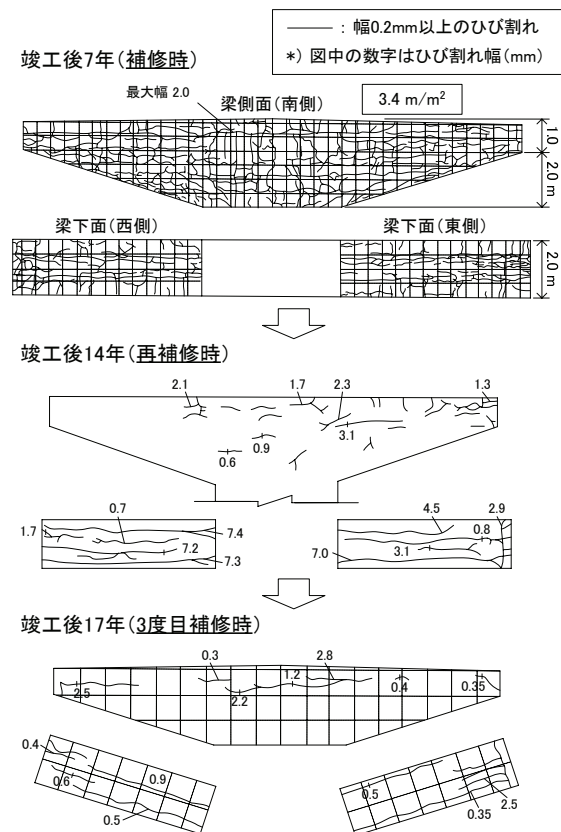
外観のひび割れ調査例 (E 橋脚)
